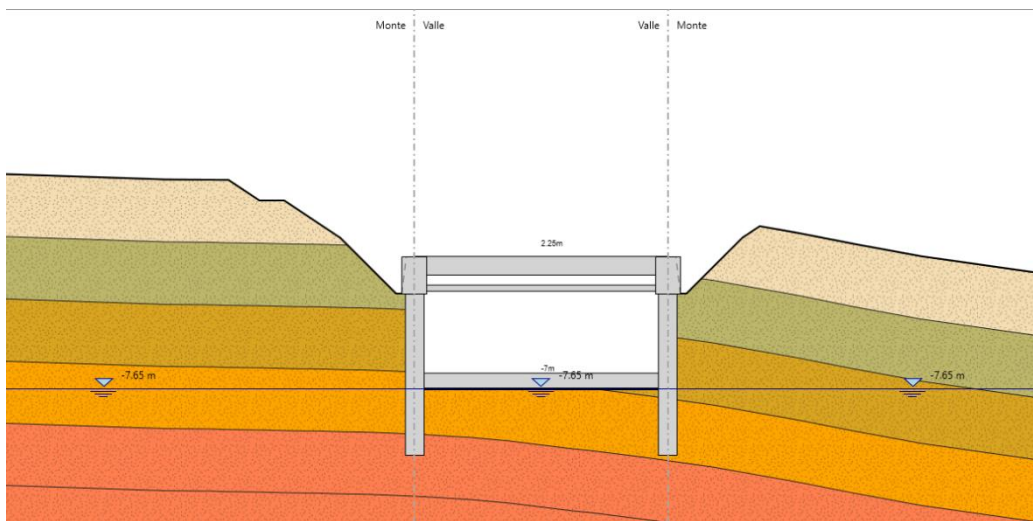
Fase 4-getto della soletta superiore e di quella di fondazione
